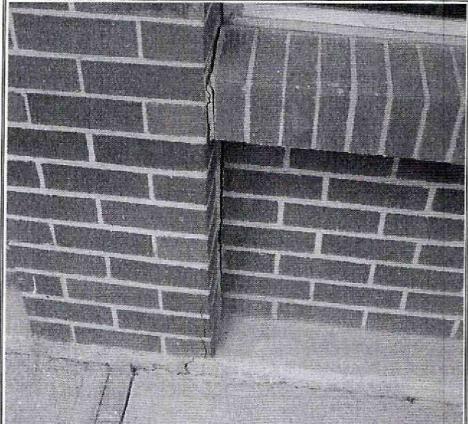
Dilatación entre los mampuestos costado norte del Jardín Infantil Atalayas, emplazado en el predio de la Calle 59 C Sur No. 89 B – 45
